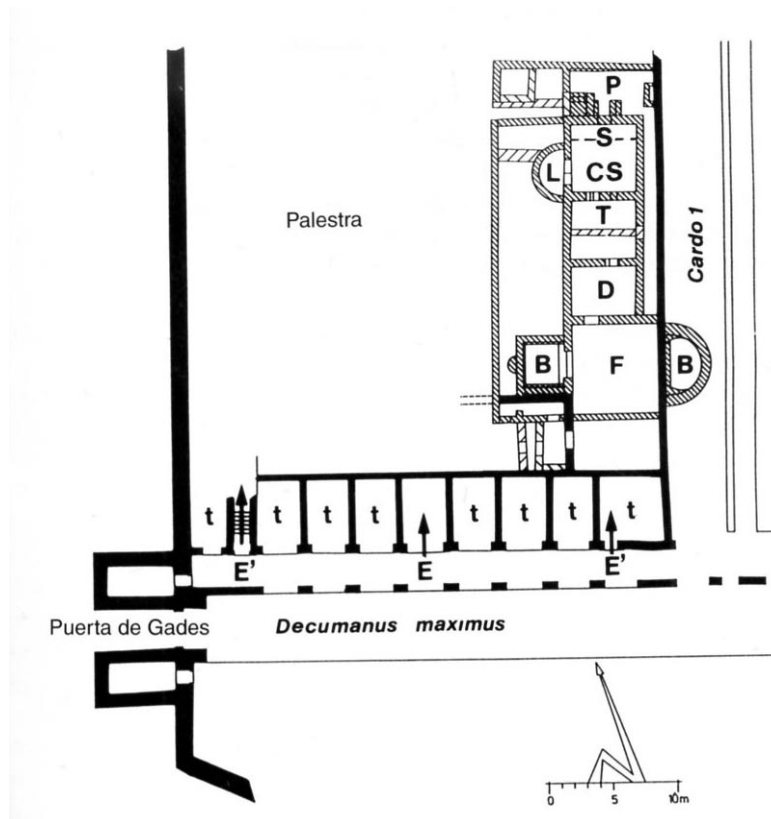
Planta de la Palestra junto a la puerta de Gades (*Baelo Claudia*, Cádiz) (Sillières, 1997: 153).
